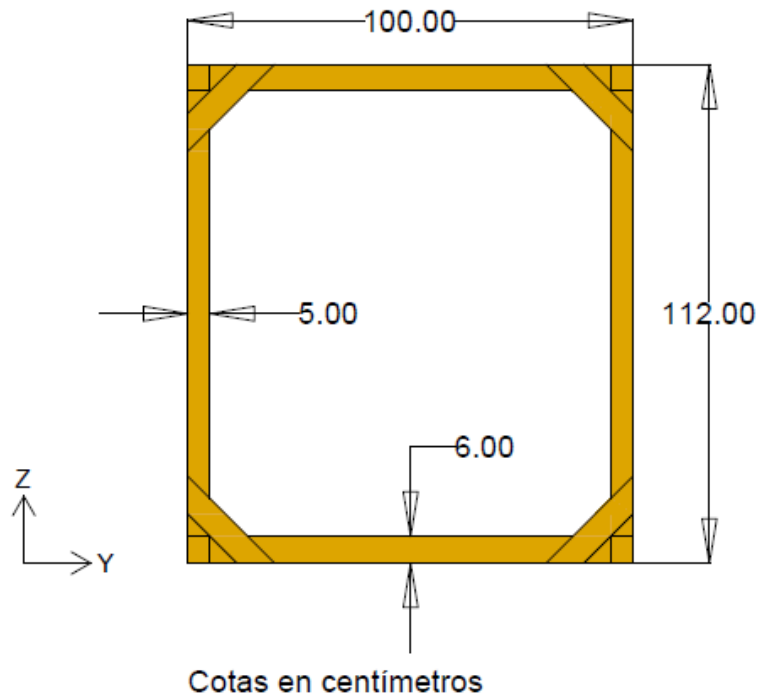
Croquis de vista de perfil de la estructura, plano YZ.
